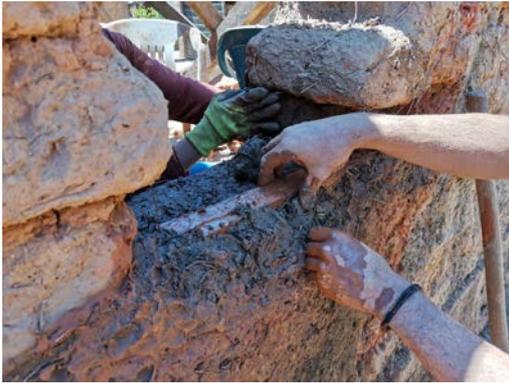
Consolidación de sección de muro de adobe de vivienda tradicional con cob y reglillas de madera como refuerzo horizontal para (Crédito:Colectiva Bioreconstruye, 2021)
